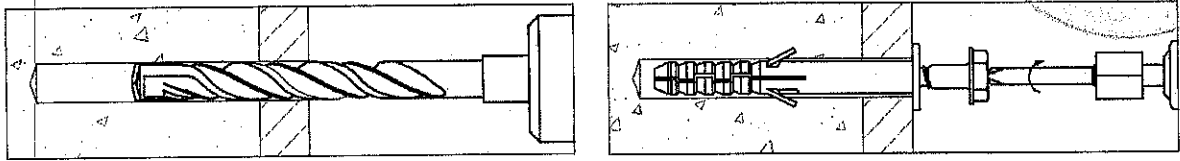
Закручиваемый способ установки дюбелей типа S-UF и S-UP
